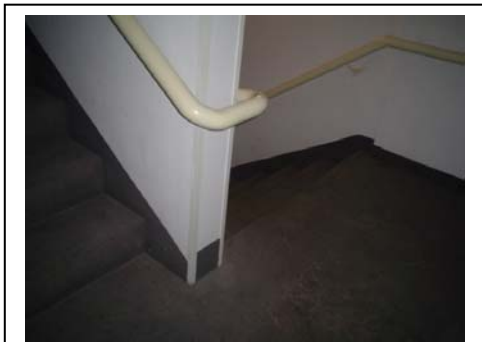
Escada de emergência – correta instalação dos corrimãos.
